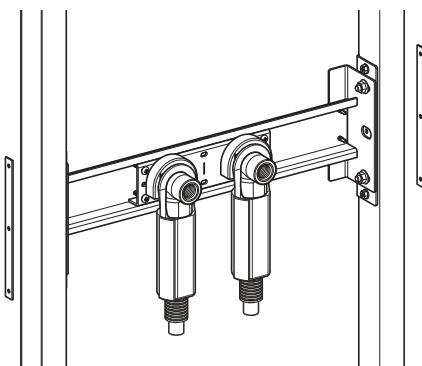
Монтаж в легкой стене с использованием монтажной планки Geberit Duofix для настенного вентиля для наружного монтажа, изменяемое положение вентиля
